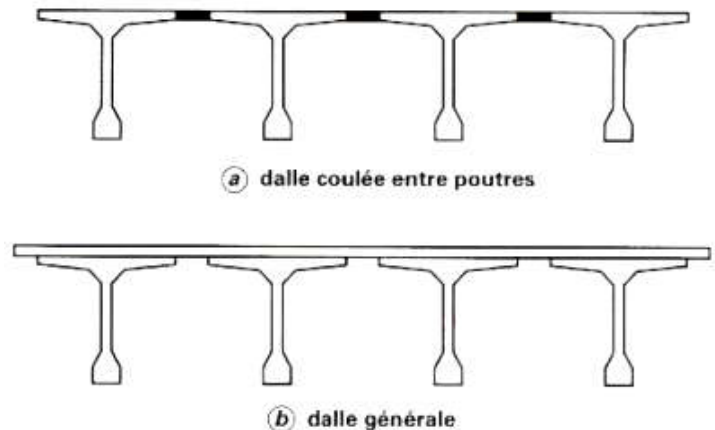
Conceptions possibles d'un tablier de pont à poutres précontraintes [8].
